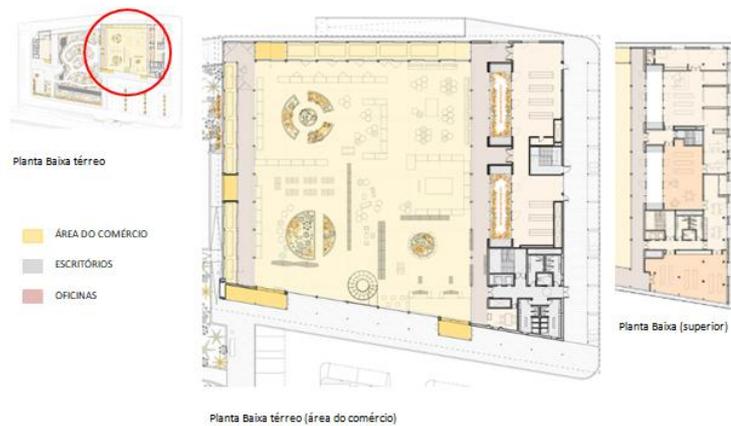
Planta Baixa do edifício Cidade do Deserto. Fonte: Garciagerman Arquitectos.
